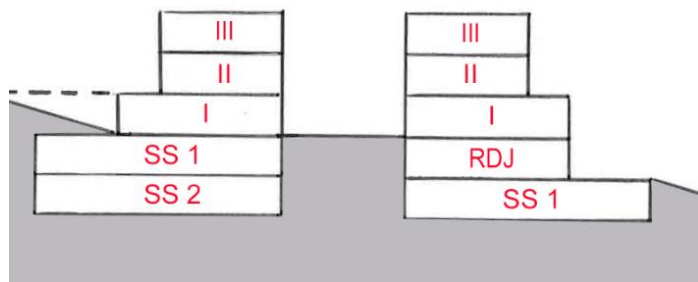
Constructions sur terrain en forte pente avec un rez-de-jardin.
